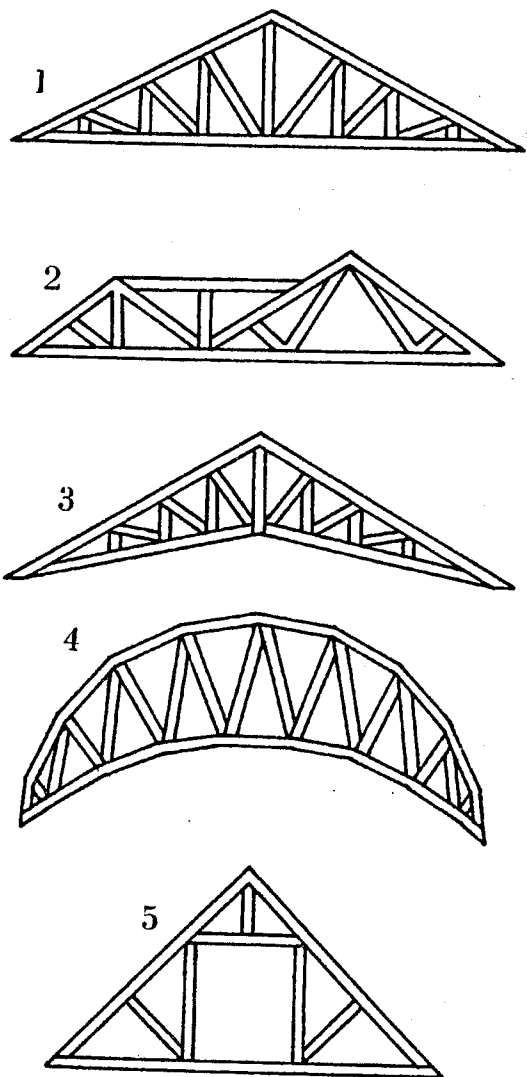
Конструкції ферм для індивідуальних будинків: 1 – двоскатна ферма; 2 – ферма зі складною формою верхнього поясу; 3 – ферма-ножиці; 4 – аркова ферма; 5 – мансардна ферма.
